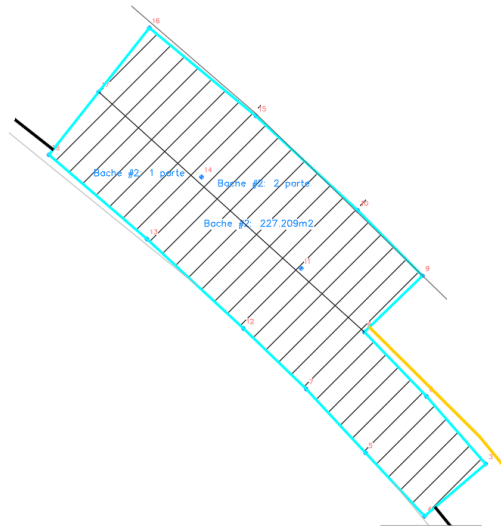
Vista en Planta de Bache #2 Primera y Segunda Parte.
